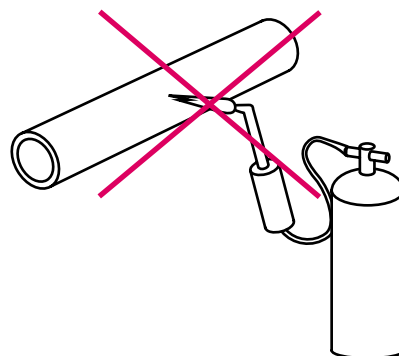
Proteggere la tubazione da surriscaldamento non ammesso
